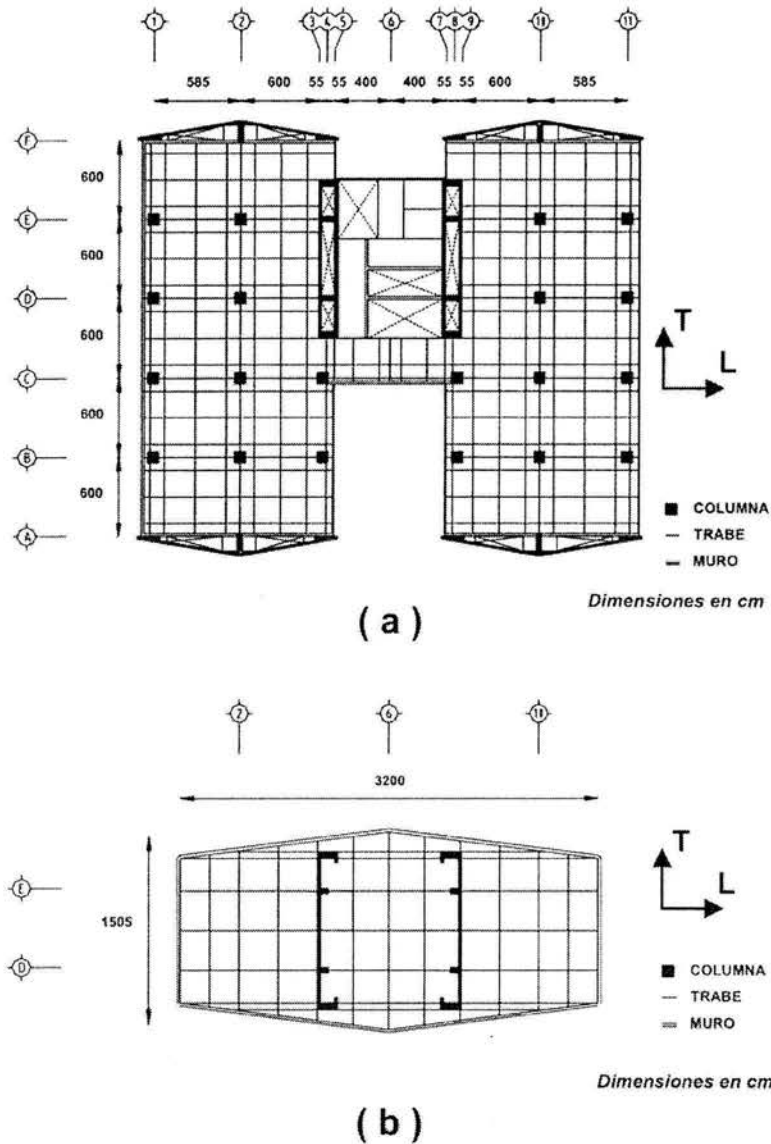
Plantas del edificio: (a) Planta tipo niveles 4 a 16 y (b) Planta tipo de los niveles 17 y 18
